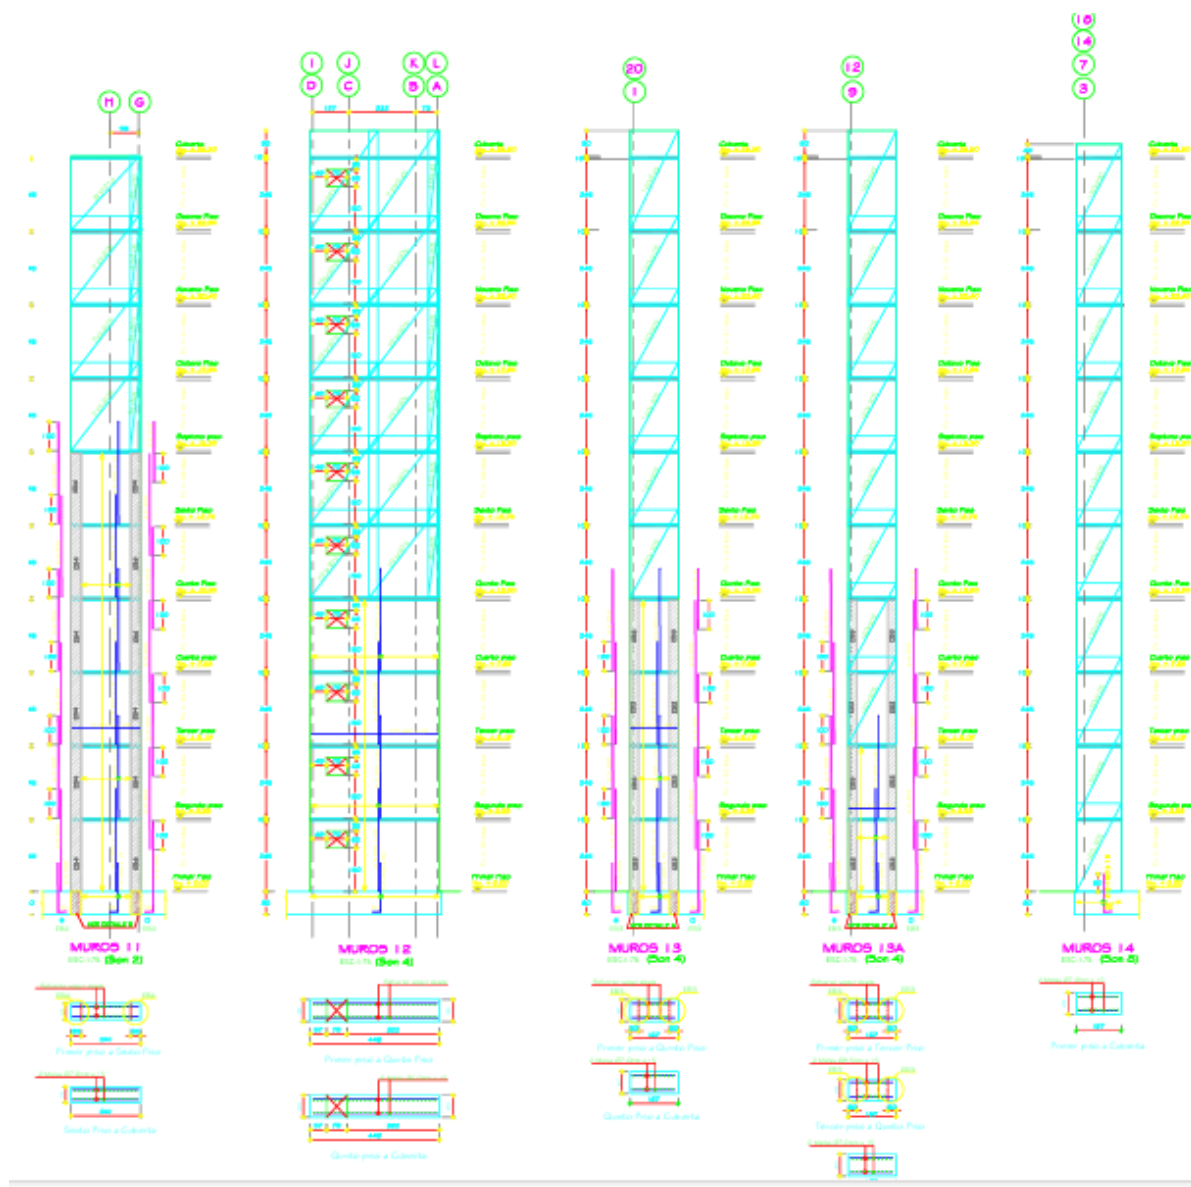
Alzadas de muros 11-12-13-13A-14
